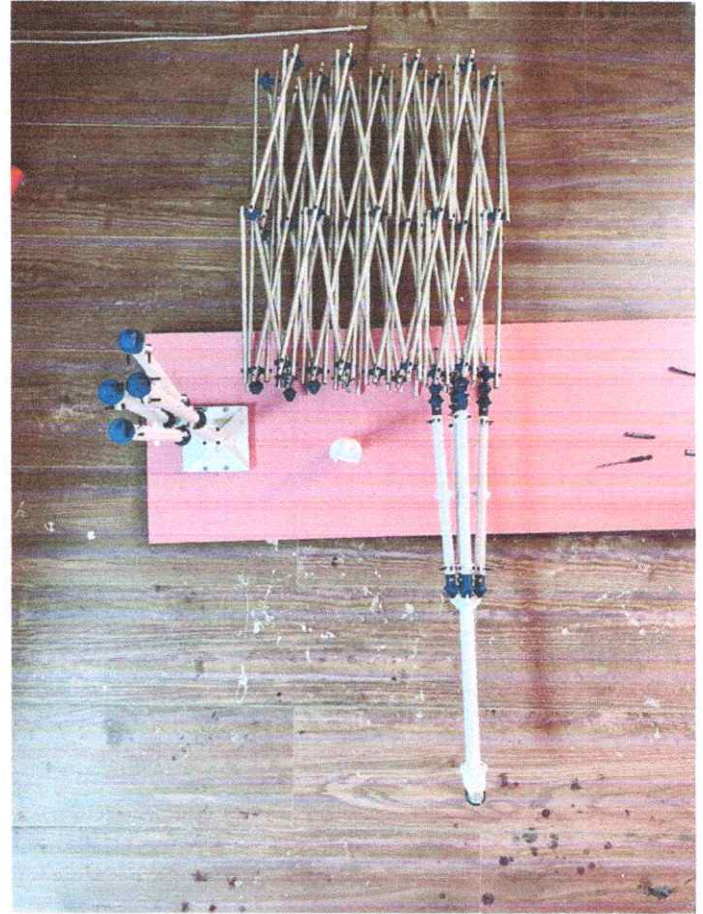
Ensamblaje de estructura lineal con un soporte al segundo apoyo.
